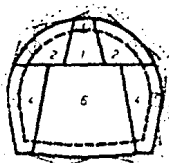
METODO DE LA GALERIA DE CLAVE EN MAL TERRENO (GALERIA DE CLAVE); 2. ENSANCHOS DE LA BÓVEDA; 4. EXCAVACION DE LOS MUROS; 5. DESTROZA Y SOLERA (EVENTUALMENTE).
